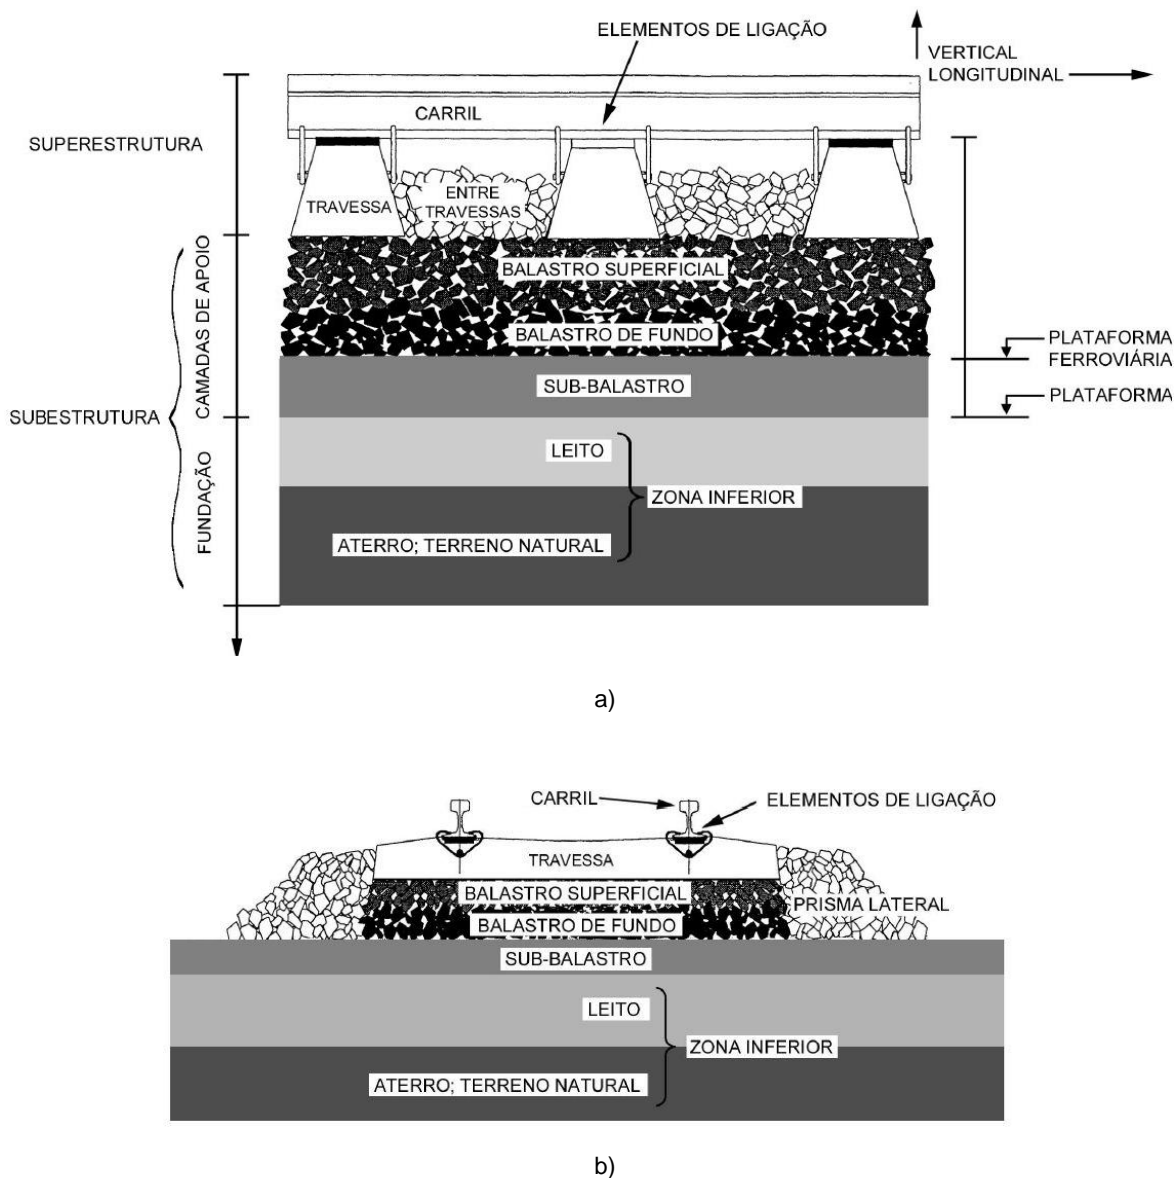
Esquema estrutural da via balastrada: a) perfil longitudinal; b) perfil transversal (Fortunato, 2005)
